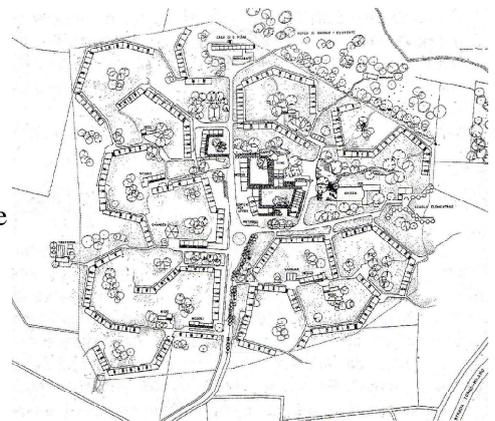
Planimetria generale, "primo progetto" 1954
